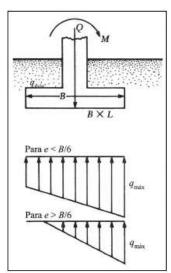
Efecto de la excentricidad en el Cimiento. (Das, Fundamentos de Ingenieria Geotecnica, 1999)
